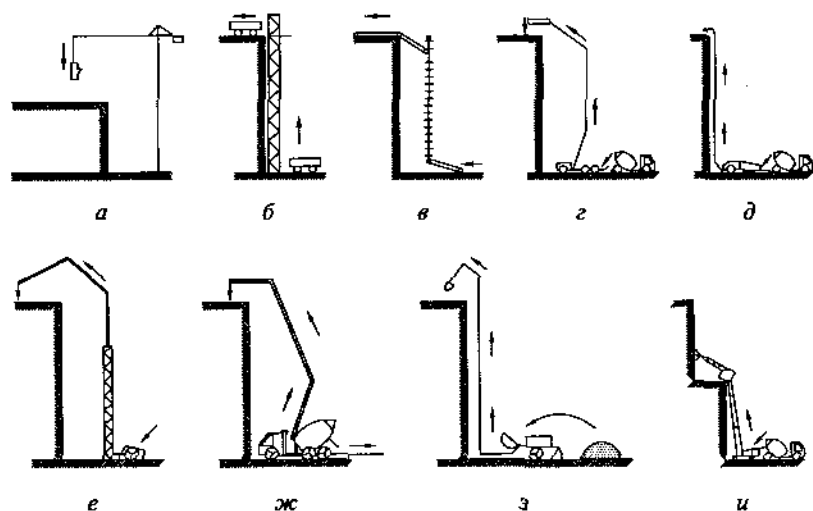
Технологические схемы подачи и укладки бетонной смеси
